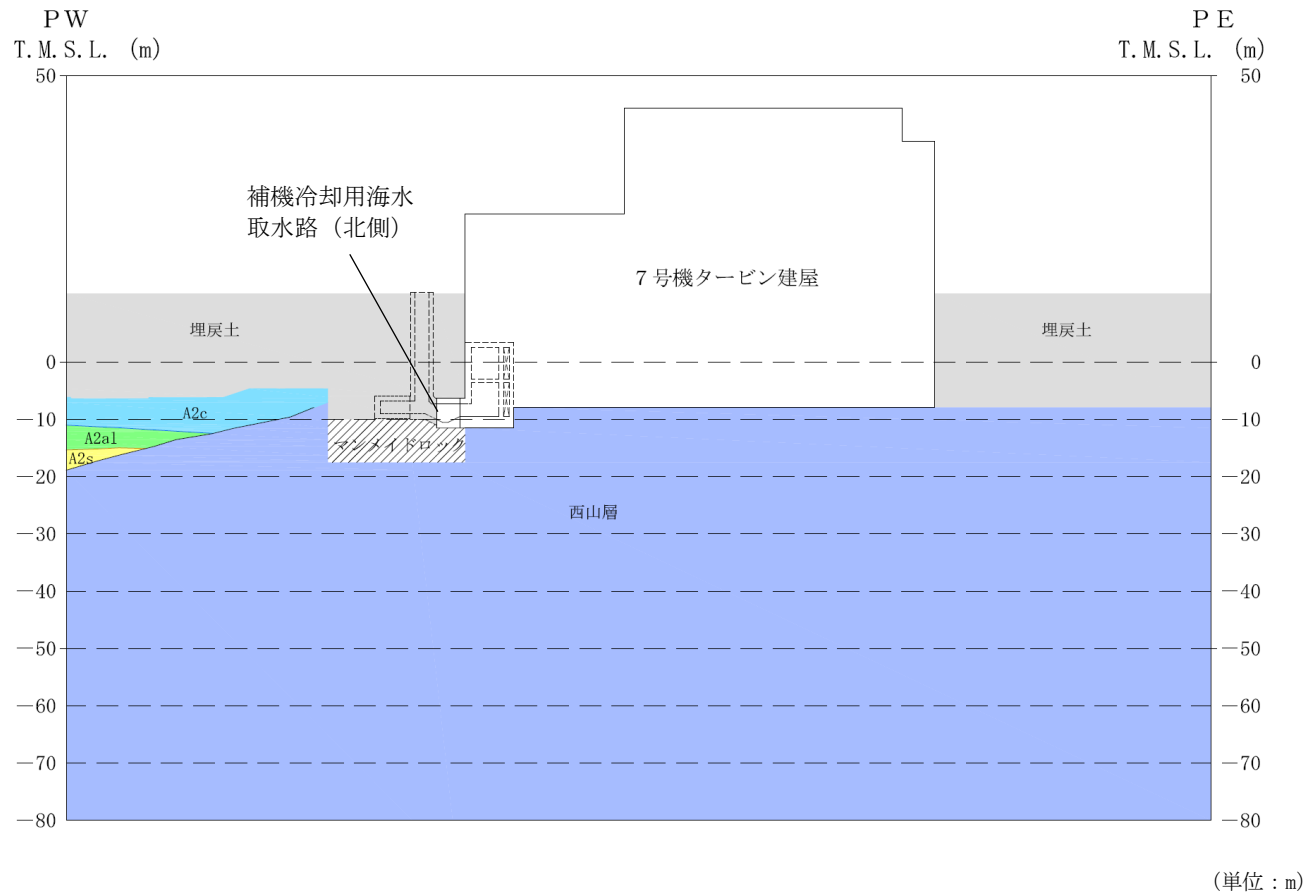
補機冷却用海水取水路 (北側) の縦断方向周辺地質断面図 (C-C断面)
